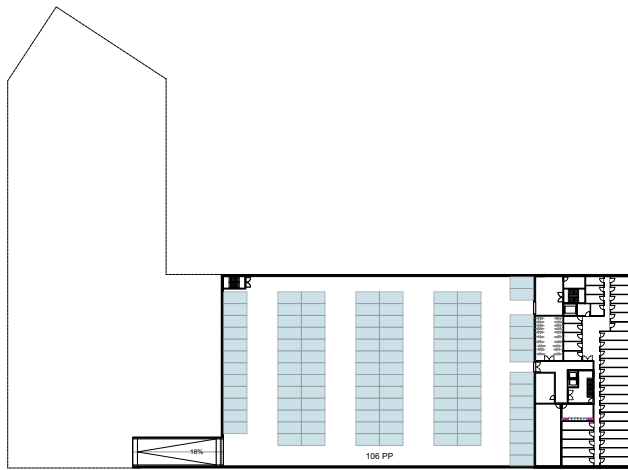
Einstellhalle im zweiten Untergeschoss (Parkierung Auto)
